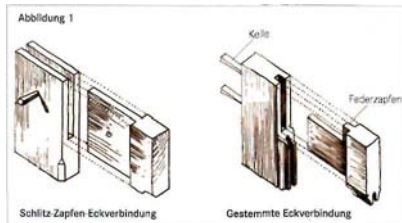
Gründerzeituren sind überwiegend gleich aufgebaut. Typisches Merkmal ist ihre „gestemmte“ Rahmenkonstruktion mit einer Schlitz-Zapfen-Verbindung, bei der zwei Hölzer über eine „gestemmte“ Passform ineinander gesteckt werden.
